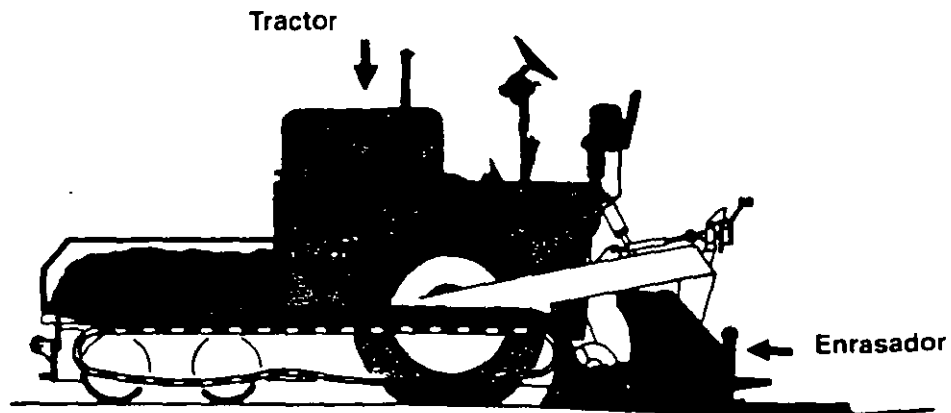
Unidades de Potencia y Enrasador de una Pavimentadora.
